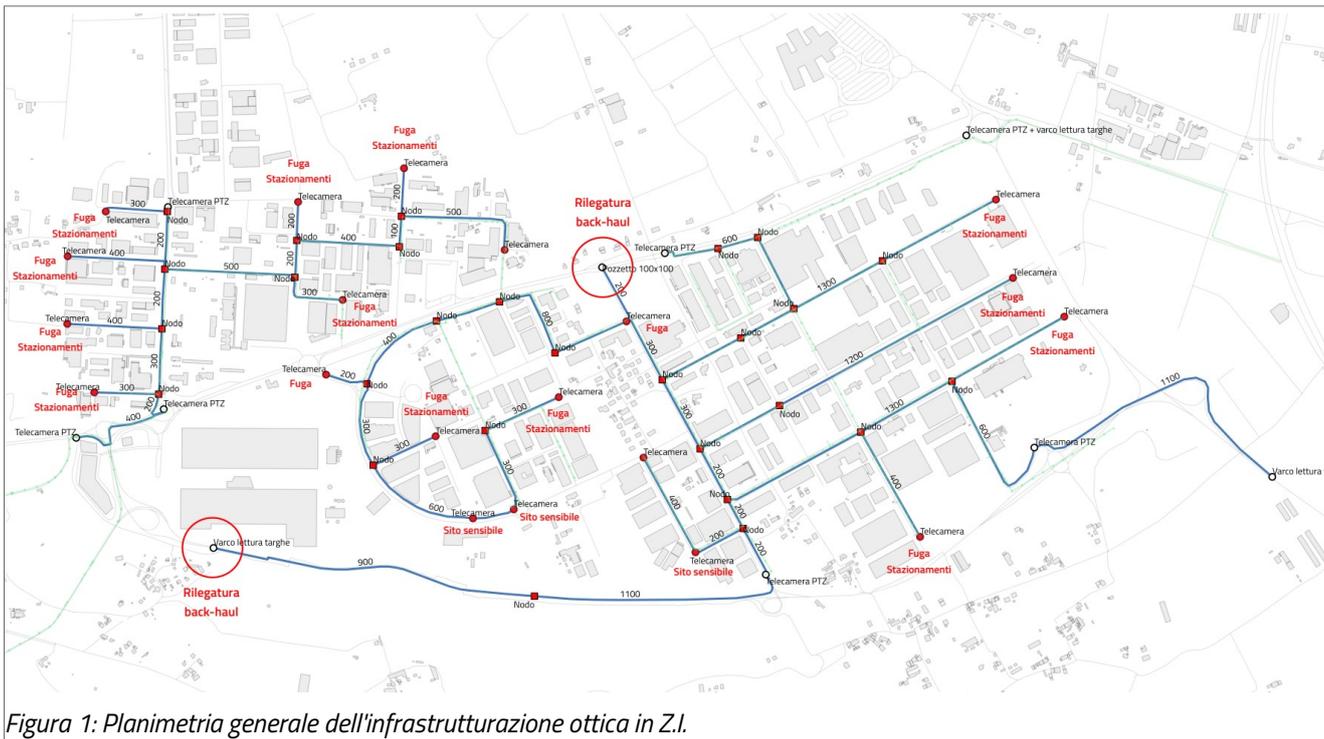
Planimetria generale dell'infrastrutturazione ottica in Z.I.
